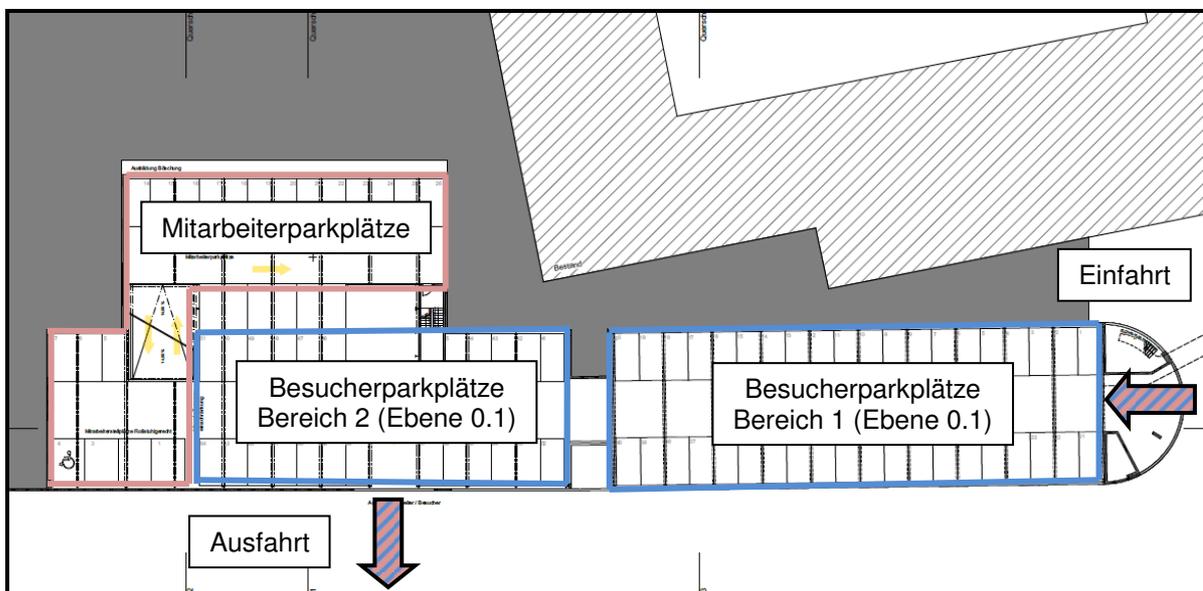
Grundriss der untersten Parkhausebene (Ebene 0.1)
